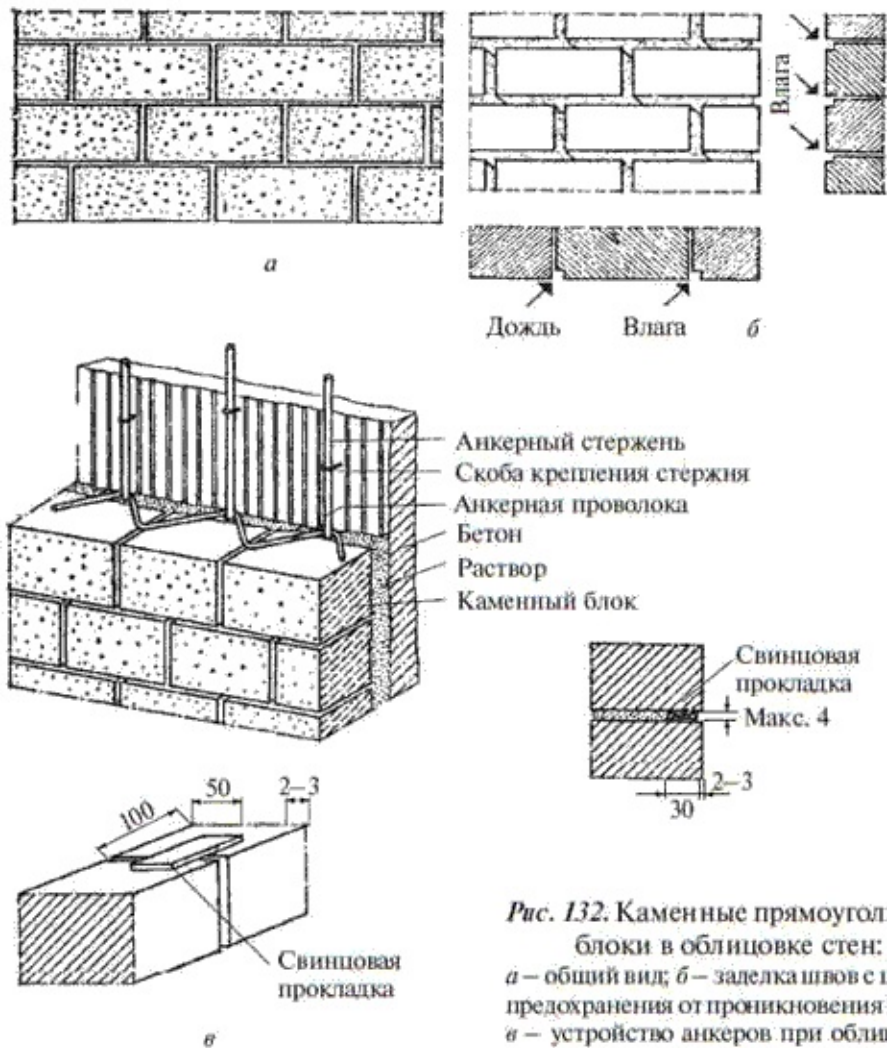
Каменные прямоугольные блоки в облицовке стен:
